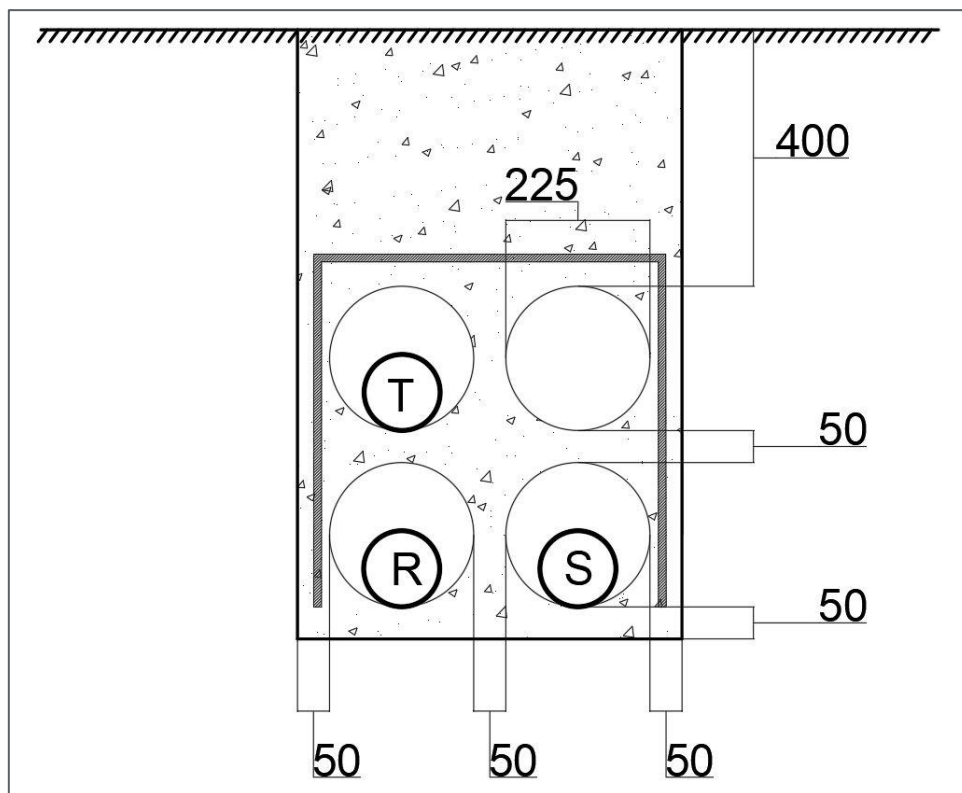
Grøftesnitt med rør og kabler. Dimensjoner angitt i millimeter.
